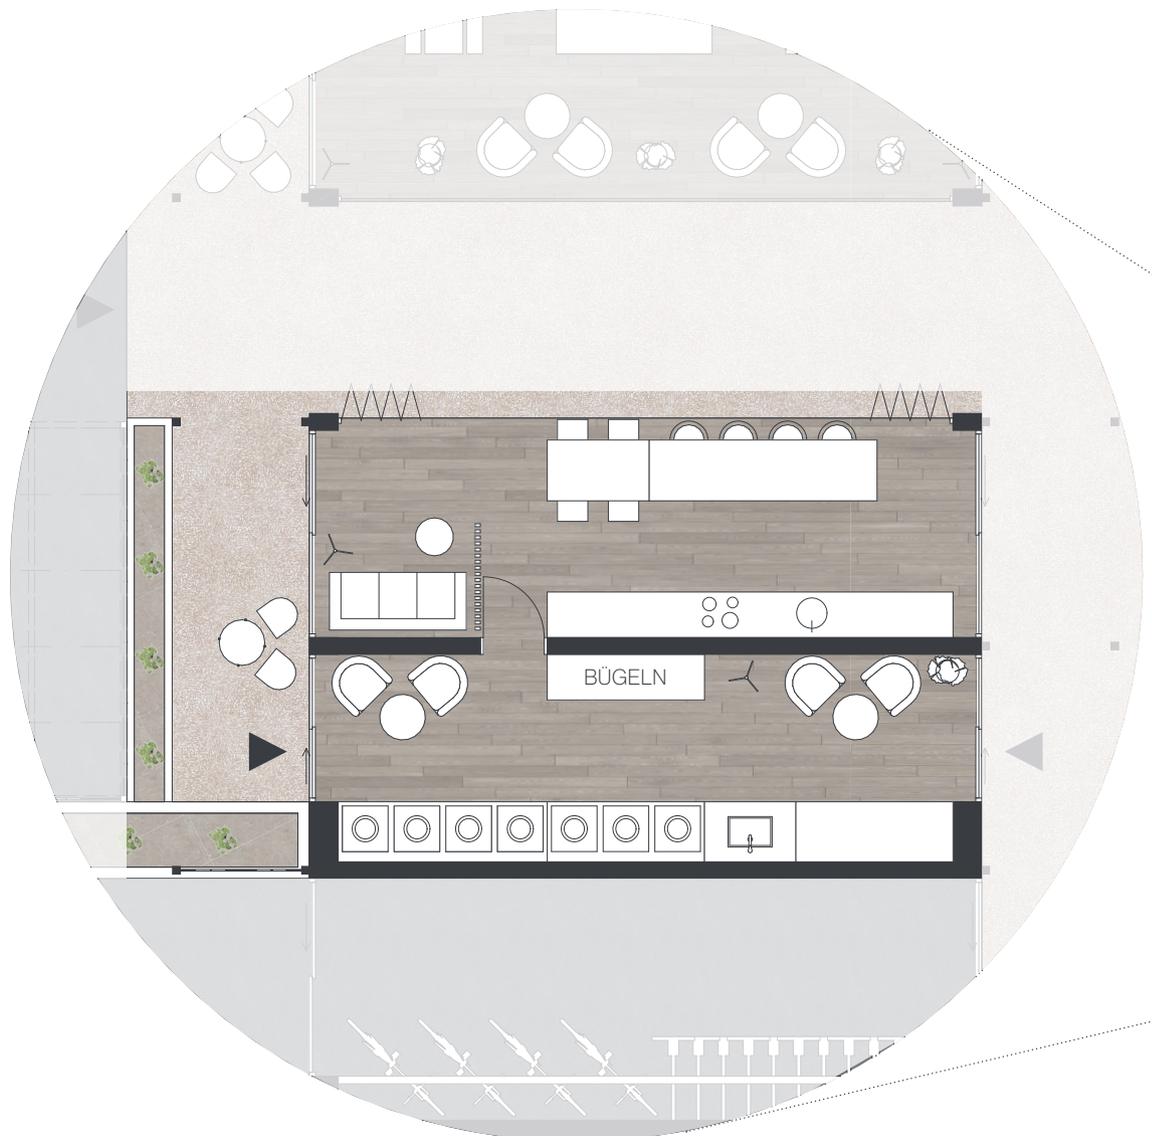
| Grundriss Erdgeschoß, hofLaden 203
